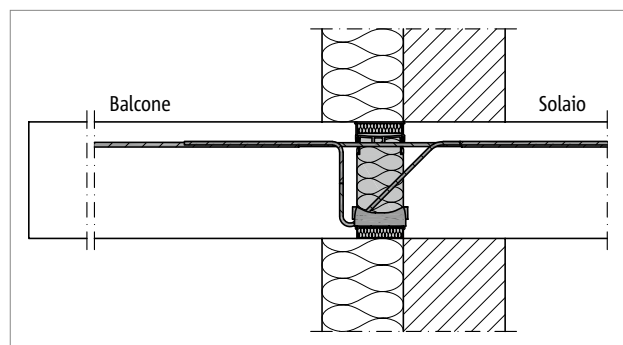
Schöck Isokorb® T tipo K: raccordo con sistema di isolamento a cappotto
